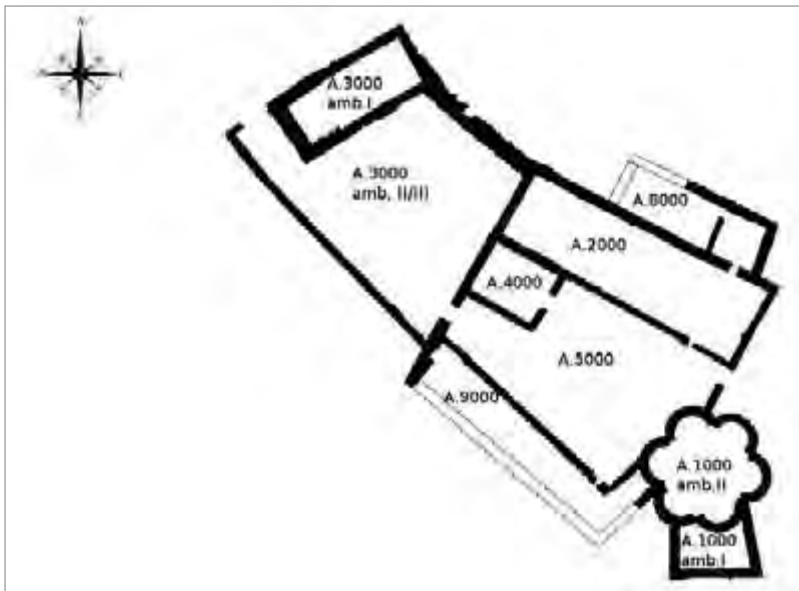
Planimetria del sito con segnate le aree di scavo.
